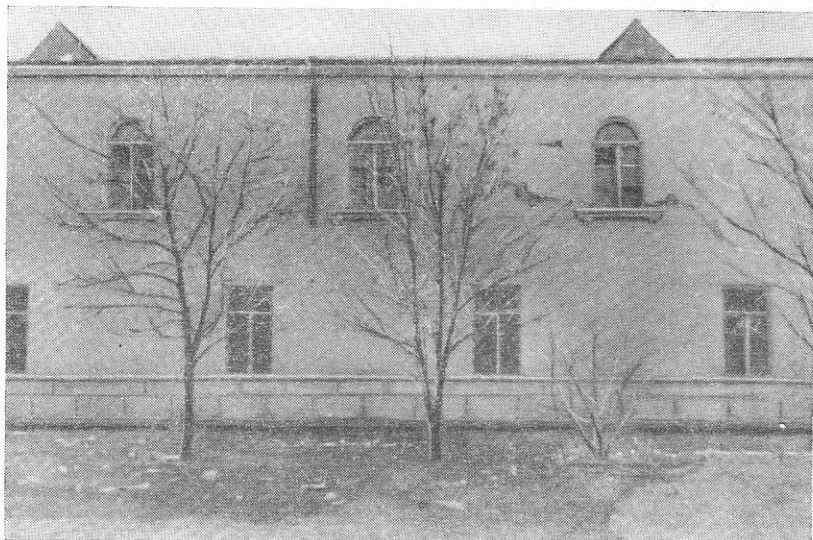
Хорошо сохранившиеся стены дворового фасада с шахматным расположением оконных проемов
